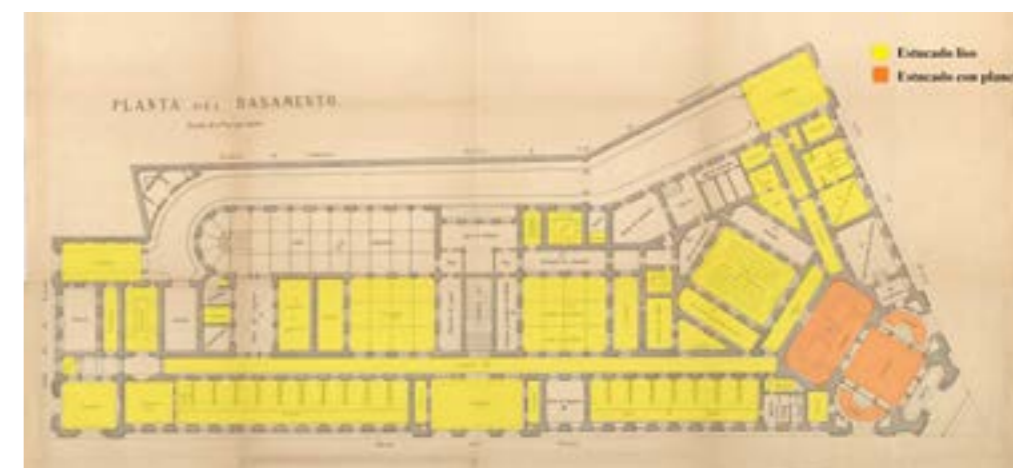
Estucos en la planta de basamento del edificio en 1891, actualmente perdidos (AHBE. Colección de Planos de arquitectura. 76/2,2)
